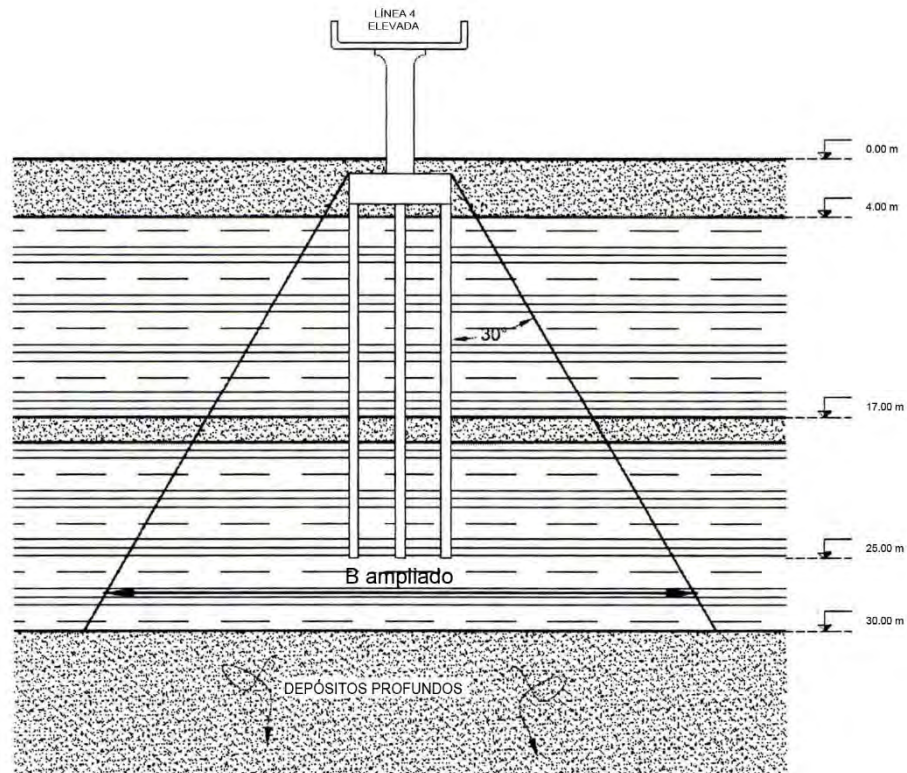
Esquema de las dimensiones ampliadas para determinar los esfuerzos en una cimentación con pilotes.
